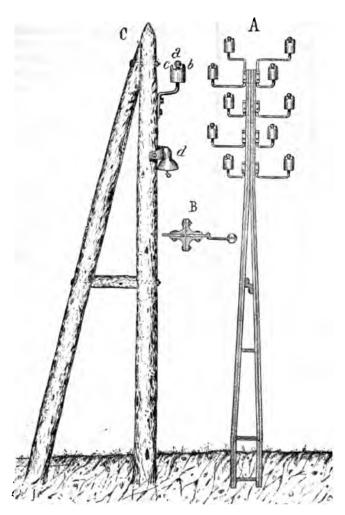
Poteau en fer Lemasson et poteaux couplés.
